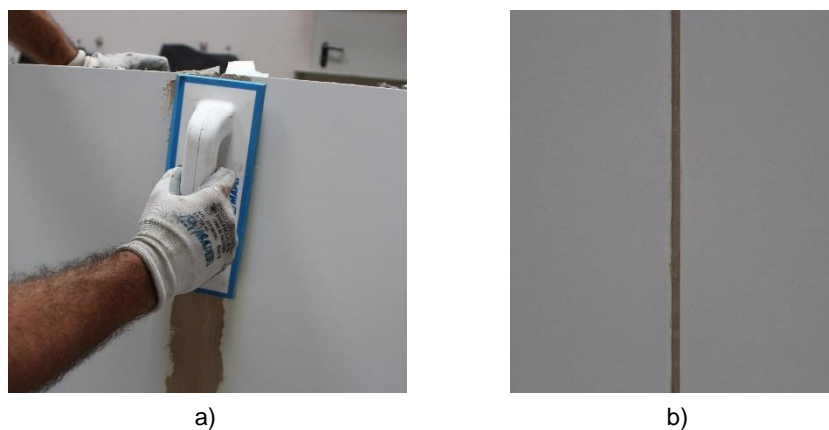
Aplicação da argamassa: a) utilização da talocha de borracha; b) pormenor da junta
